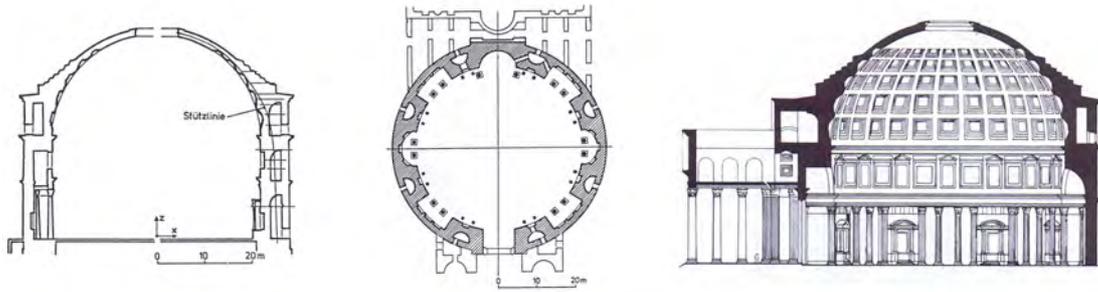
Pantheon Rom, Schnitt quer mit Stützlinie und Grundriss, Schnitt längs; Quelle: Geschichte der Bautechnik und Baukonstruktion, Mislin M.
